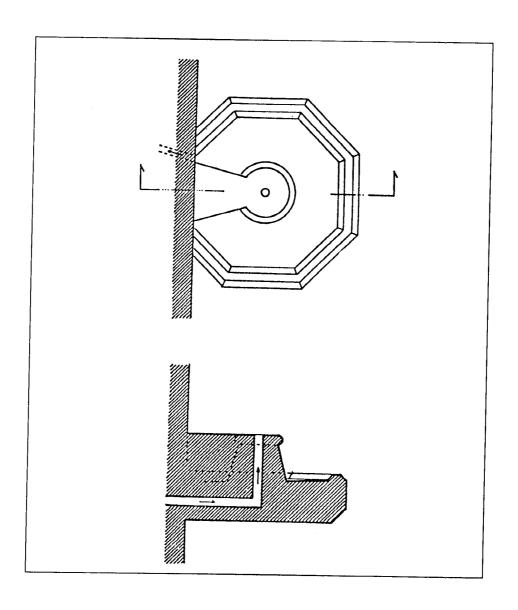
مسقط أفقي لجِشمة قره مصطفى باشا في أدرنة (عن : Ö N G E) .
